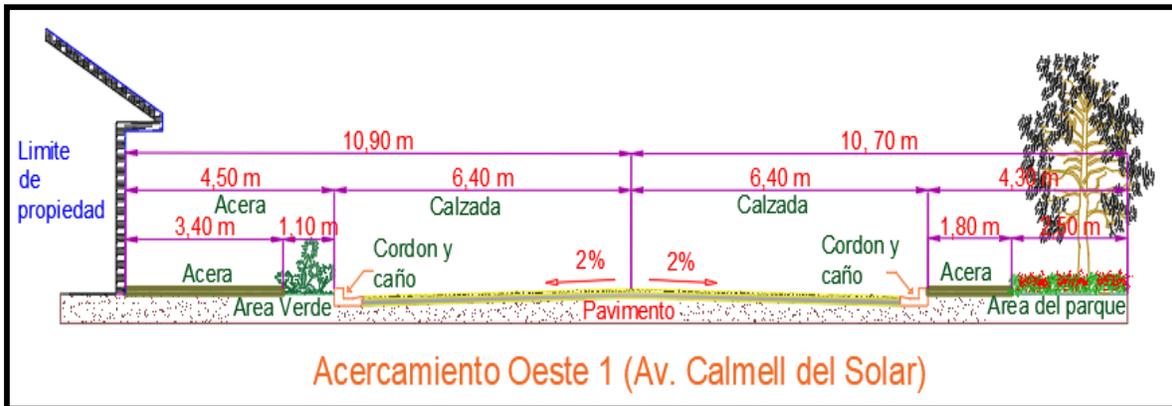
Sección transversal del acercamiento Oeste 1 – X1
